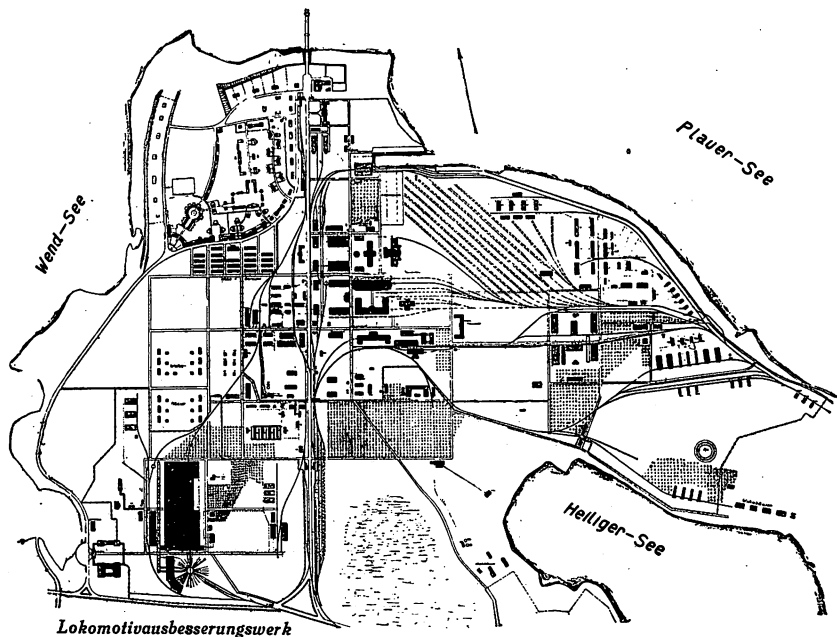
Lageplan des Eisenbahnwerkes Brandenburg-West.
